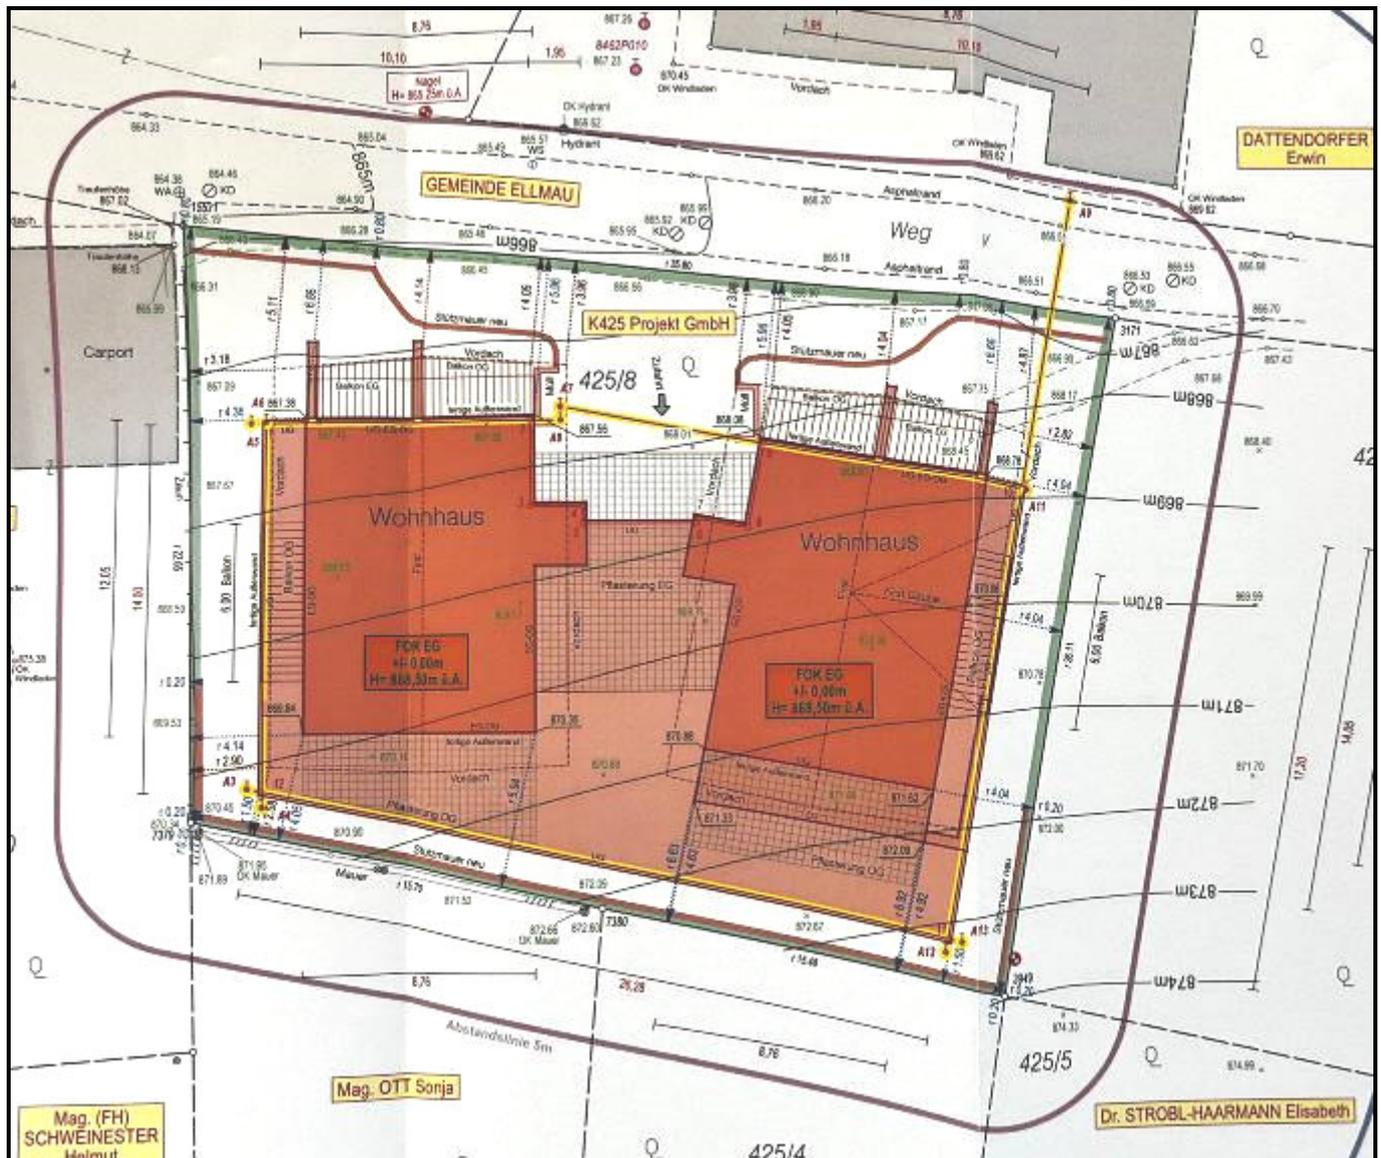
Lageplan – Situierung Einfamilienhäuser
